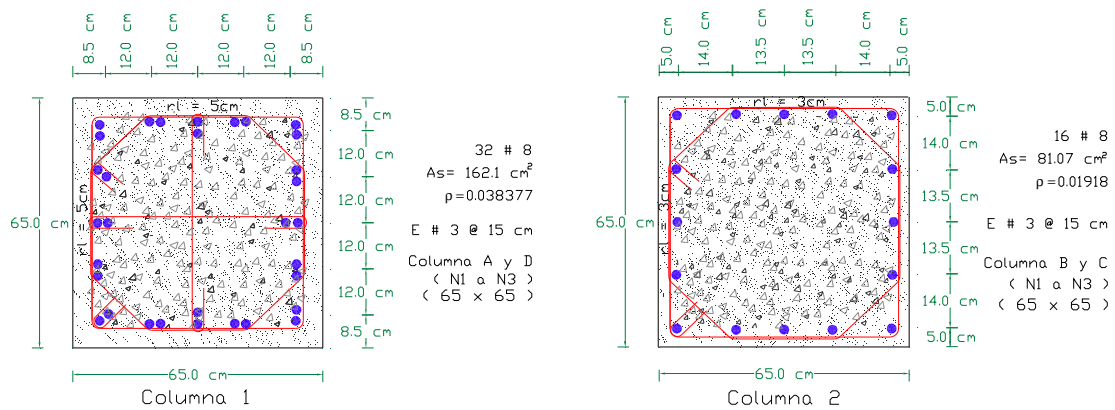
Dimensiones y armado de columnas, edificio III_3
